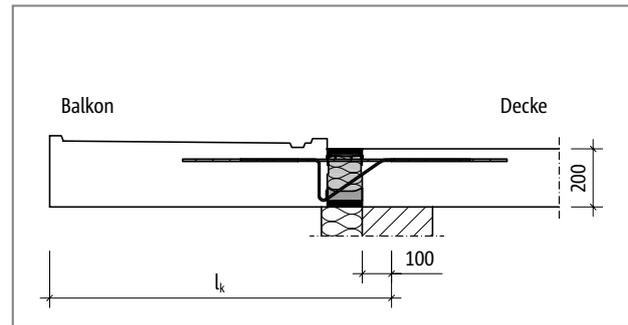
Schöck Isokorb® Typ KXT: Statisches System
